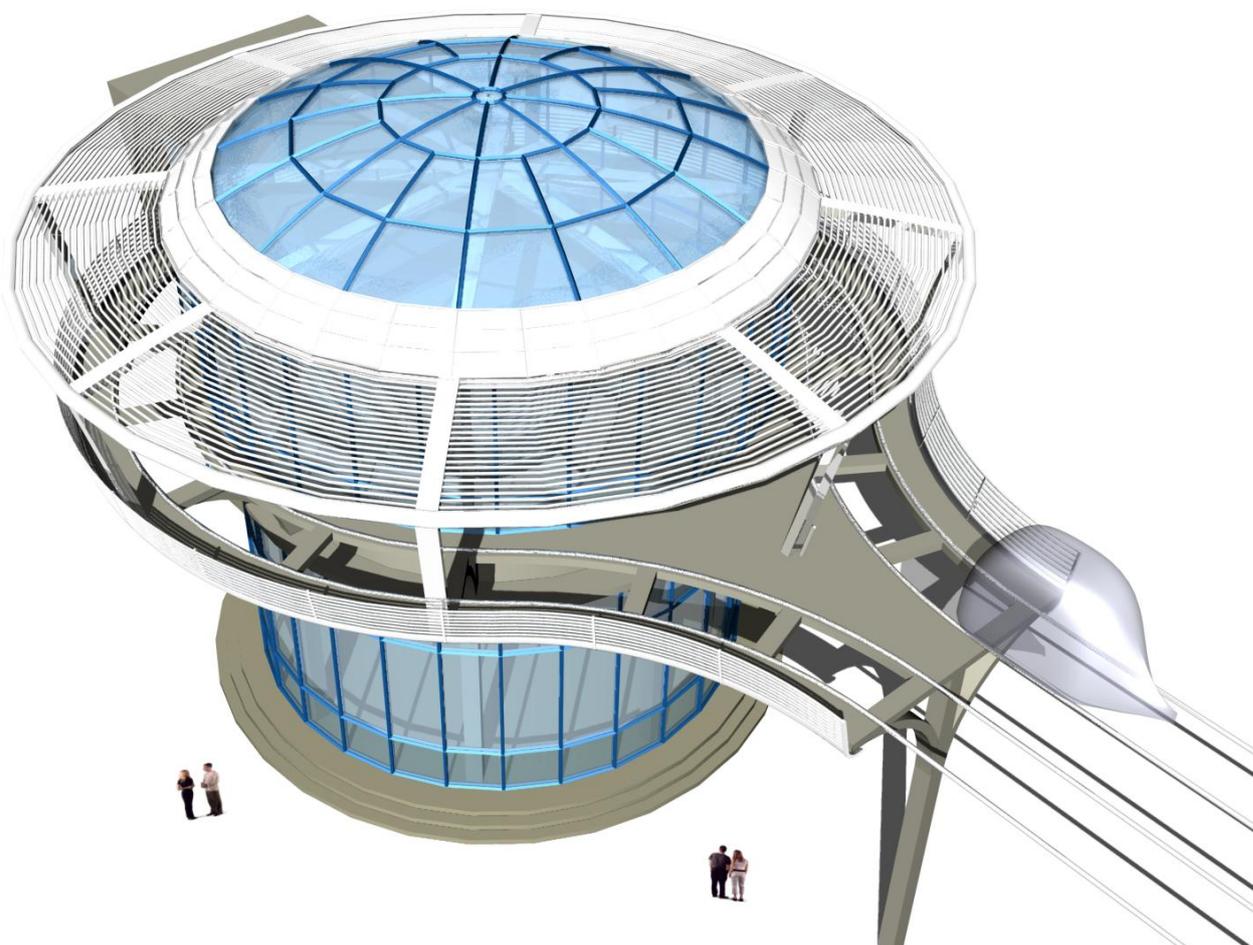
Разворотная станция двухпутного бирельсового СТЮ (вид сверху)
